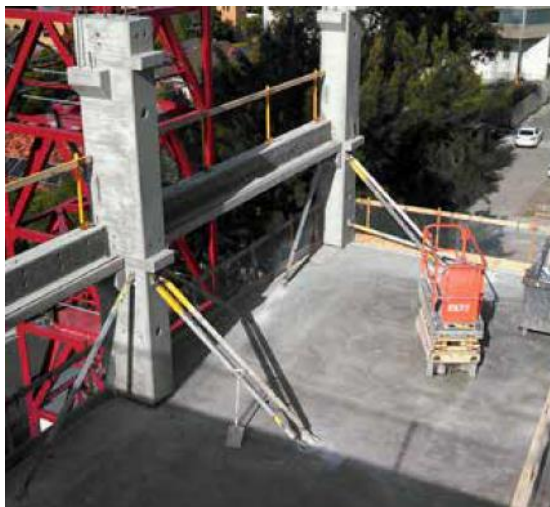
Ligação de pilar contínuo com cachorro e quadril [3]
